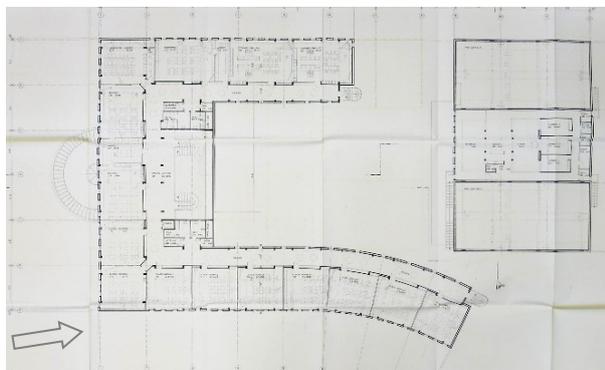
Grundriss 2. Obergeschoss, Plan vom 20.10.1989 (Bauarchiv der Gemeinde Porrentruy)
